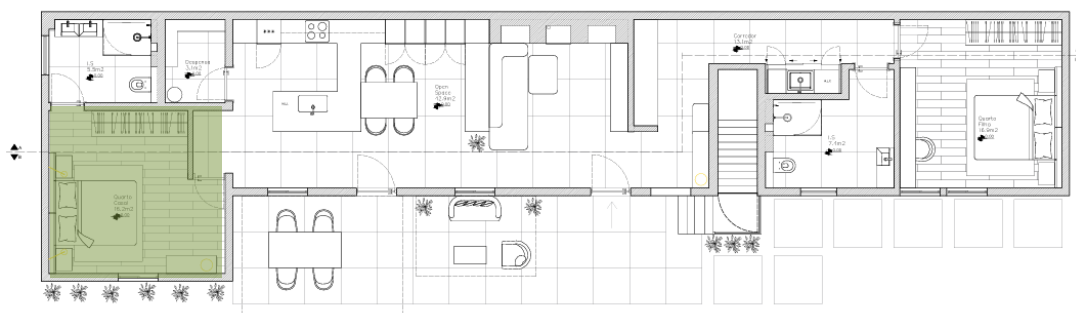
Planta de apresentação zona da suite Fonte: Autor
